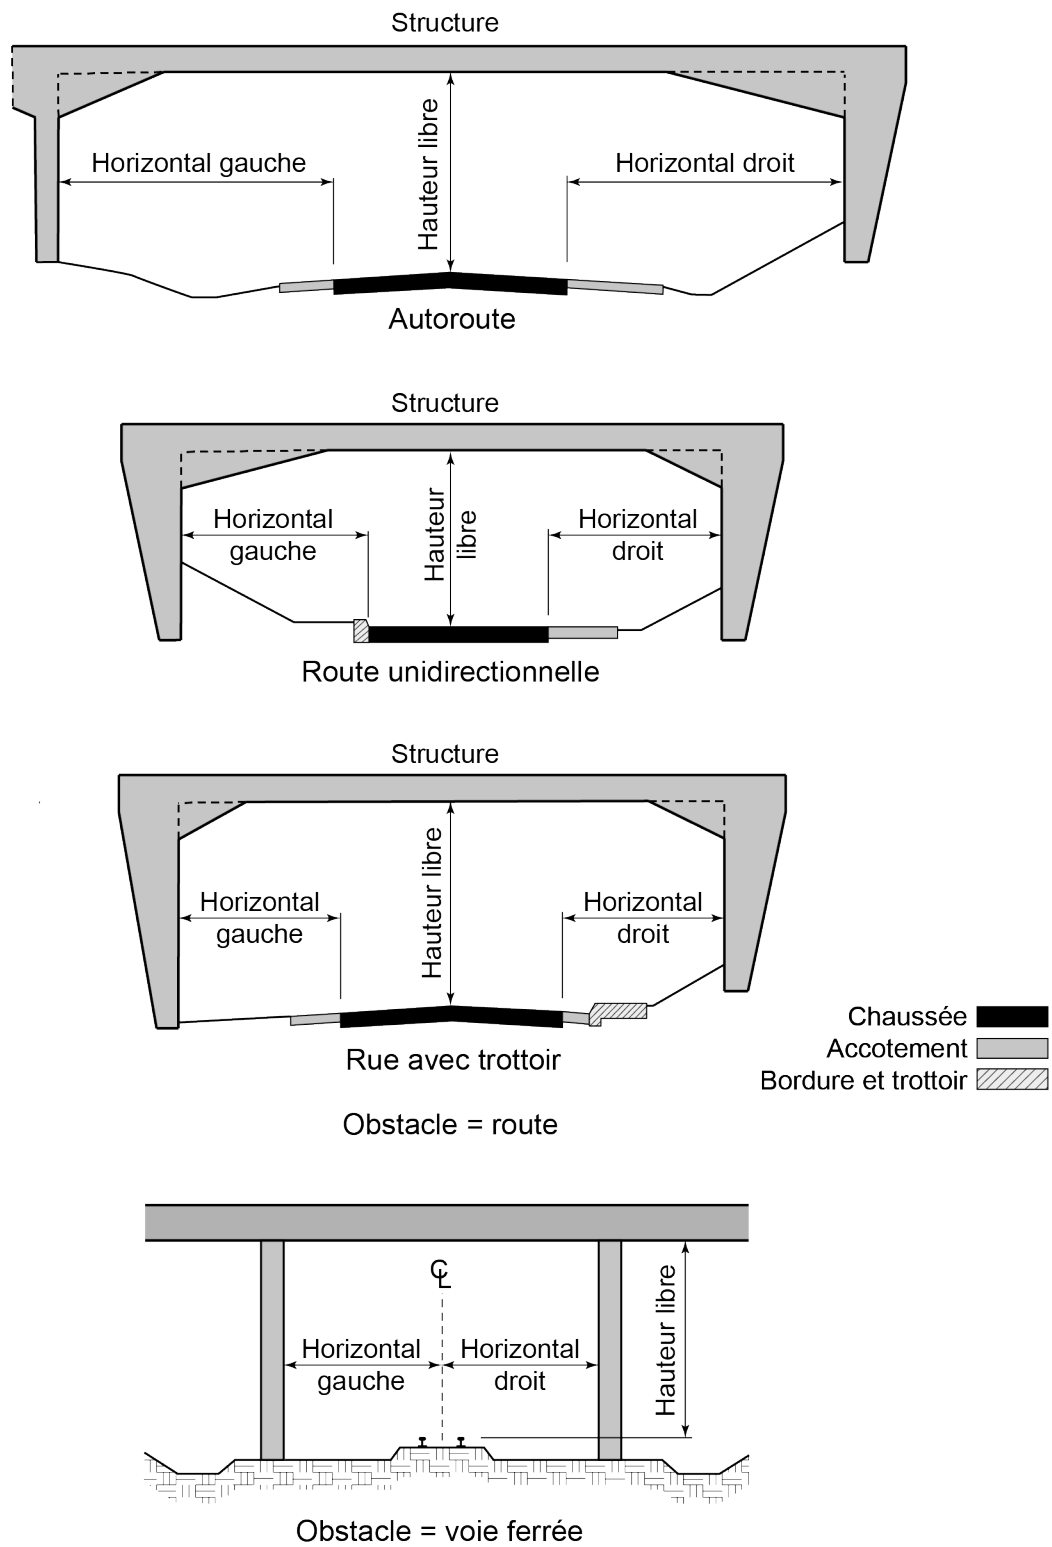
Dégagements horizontaux et hauteur libre
